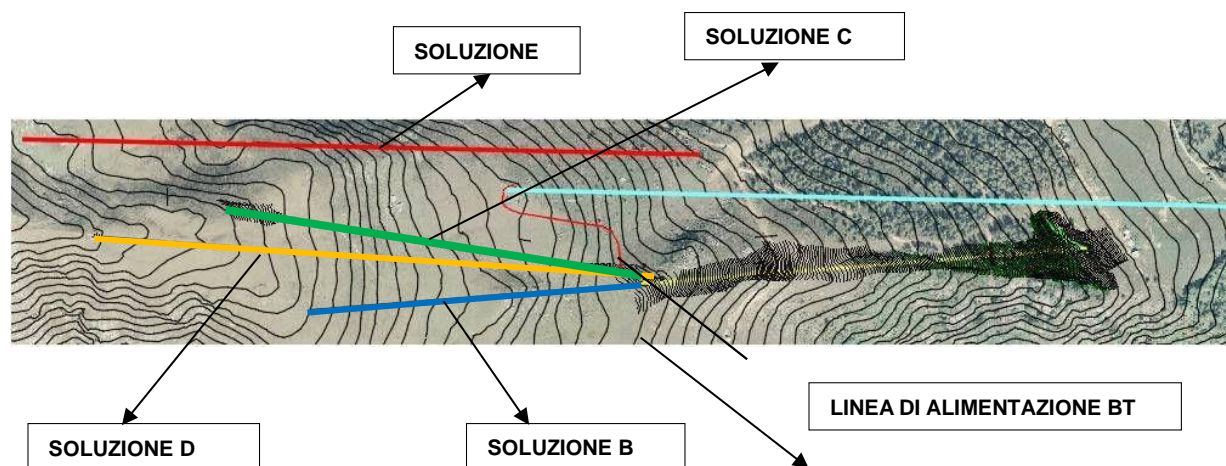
Visualizzazione planimetrica delle alternative di progetto analizzate
